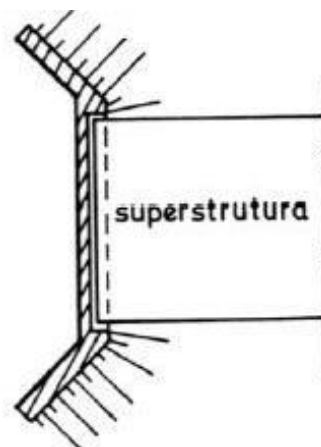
Encontro de muro de ala.(Lopes, 2018)
